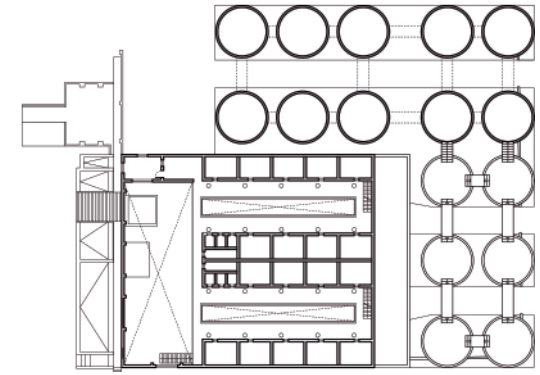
Vista superior planta y cubas. Fuente: Archivo propio.
